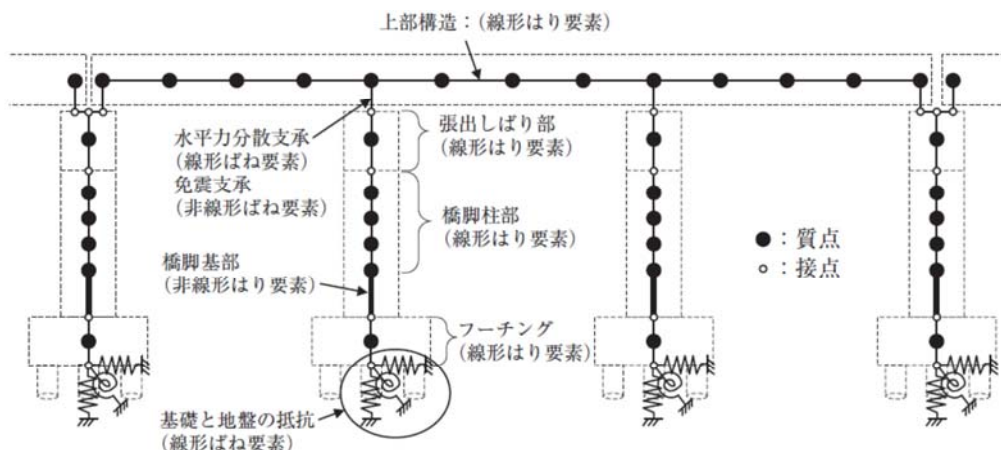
橋の解析モデルの例 (道示V編, 図-解 5.2.1)
